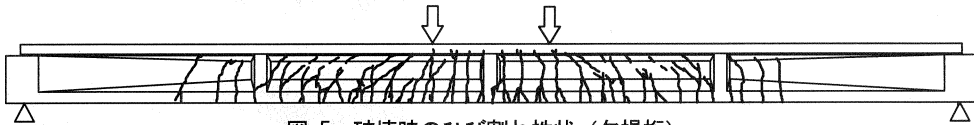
破壊時のひび割れ性状 (欠損桁)
